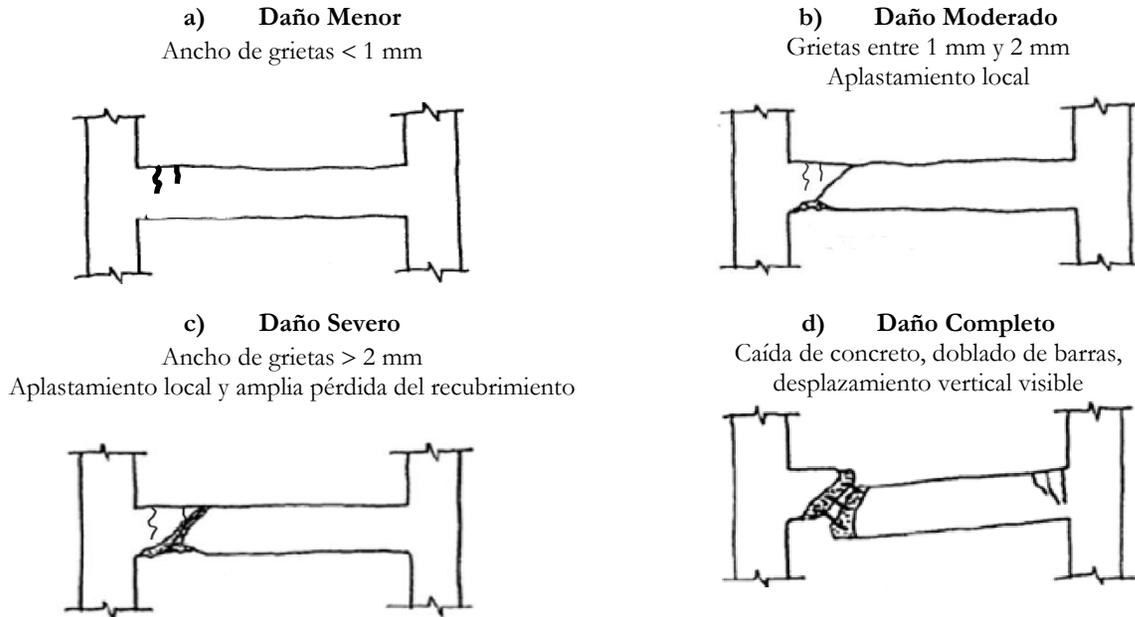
Daños en vigas de concreto armado. Adaptado de Kaminosono et al., 2002.
